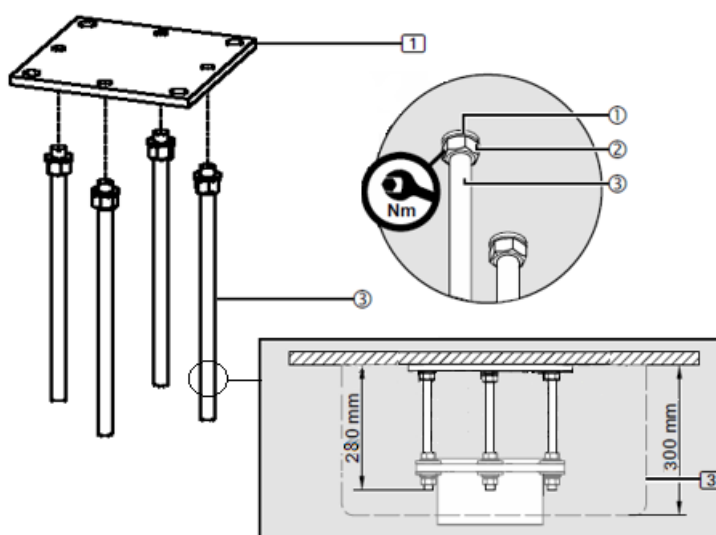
Montage van interfaceplaat zonder verlaagd plafond
